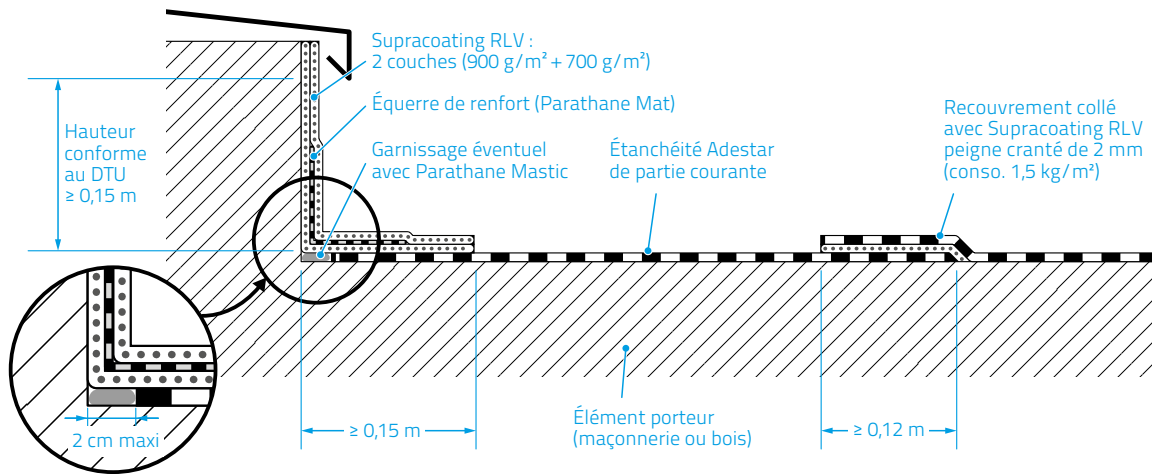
Revêtement Adestar sous protection lourde en toiture inaccessible sur élément porteur en maçonnerie ou en bois
